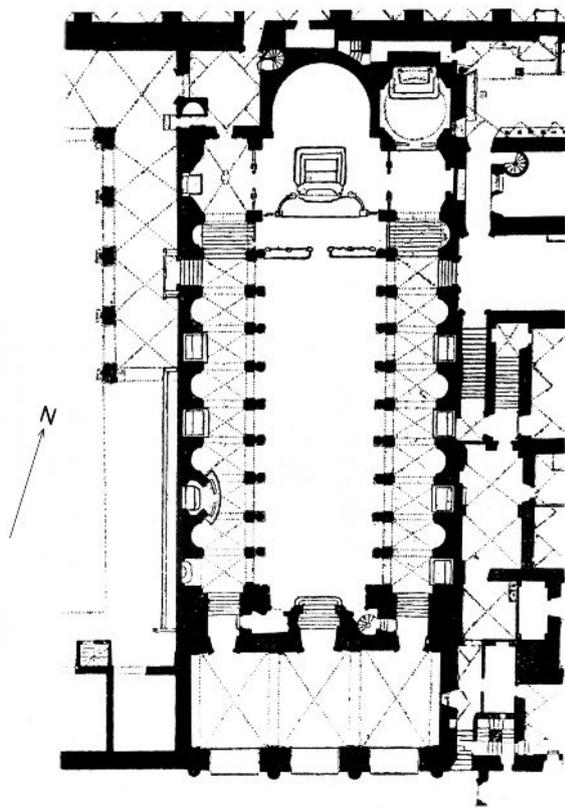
Rom, S. Marco Grundriss um 1900
